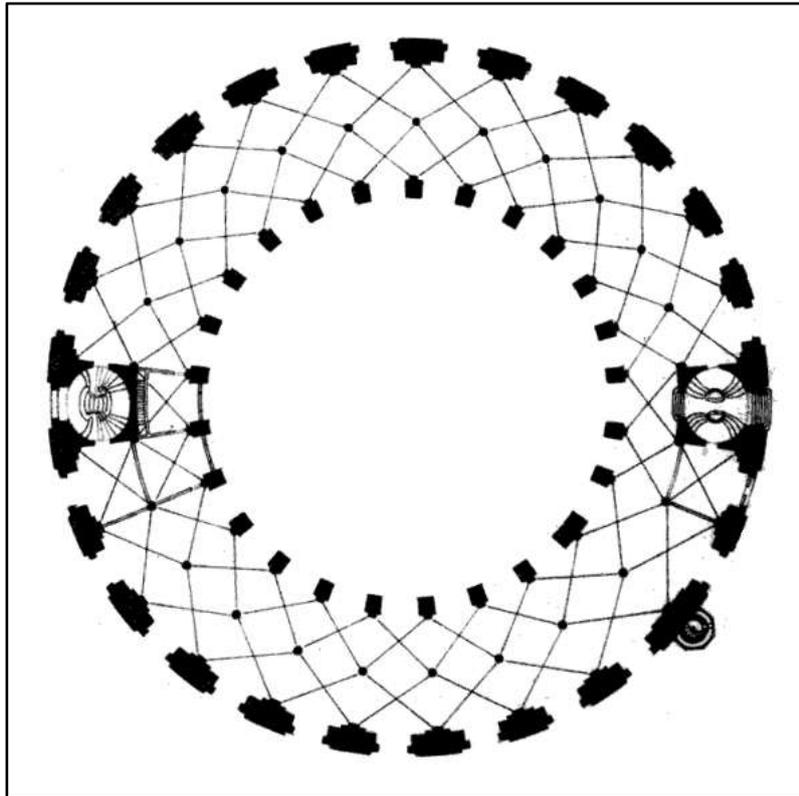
Plan de la Halle aux Blés dans LEGRAND, Jacques-Guillaume. LANDON, Charles-Paul.
